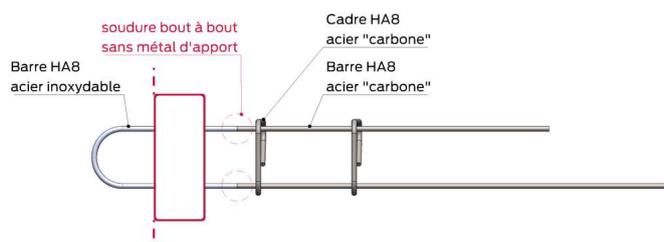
Schéma des barres d'armatures longitudinales et position de la soudure Gamme Slabe ZBA\
